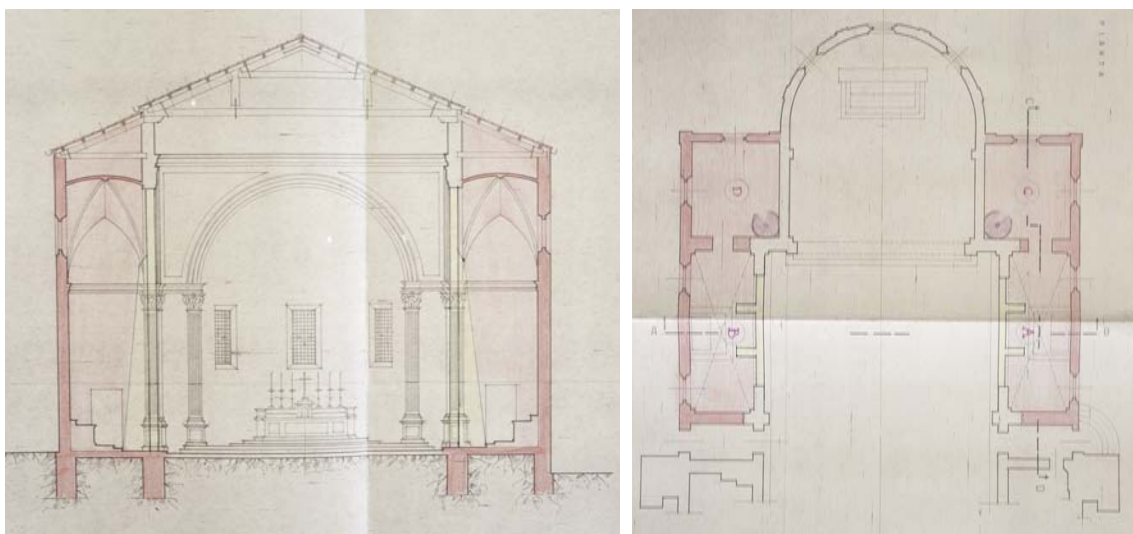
| Progetto di ricostruzione zona absidale. Sezione trasversale e pianta
